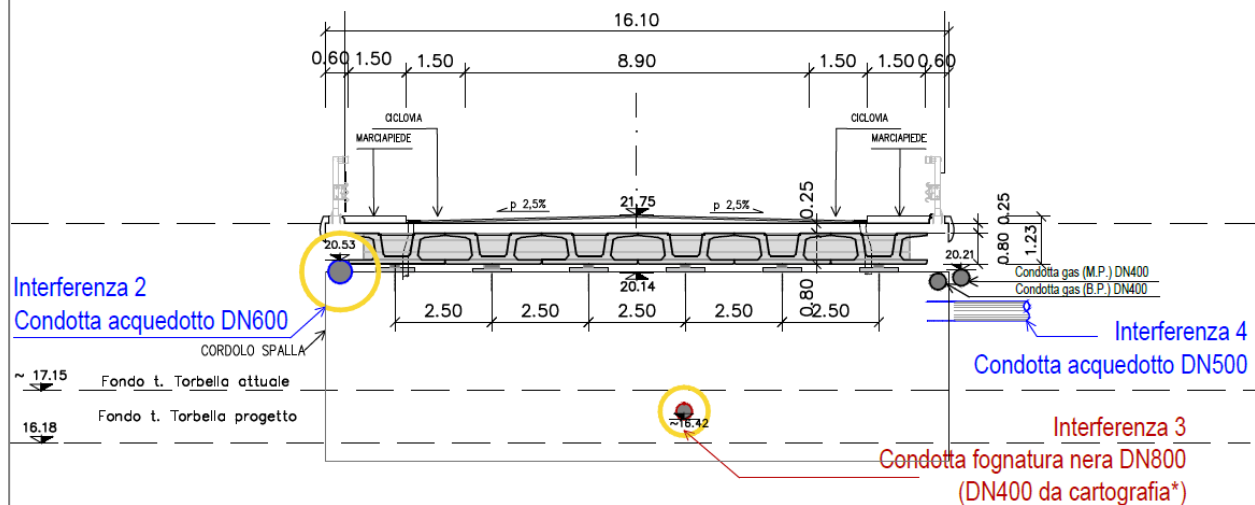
Sezione trasversale del nuovo ponte di via Canepari in corrispondenza della spalla sud
